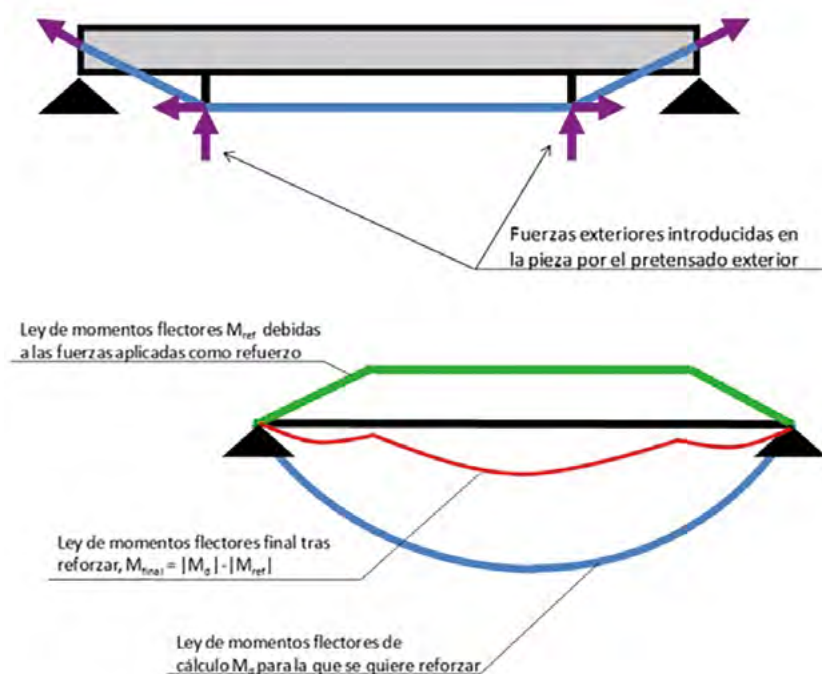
Planteamiento de un refuerzo activo de un elemento flectado.
